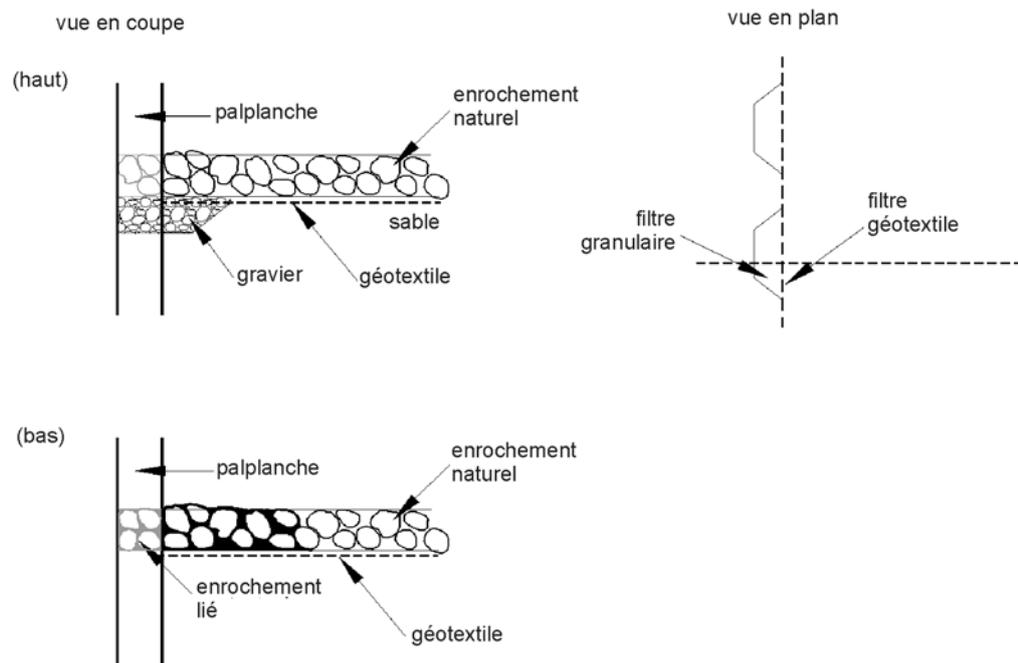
(En haut) transition verticale au niveau du lit avec une bande de graviers ;
